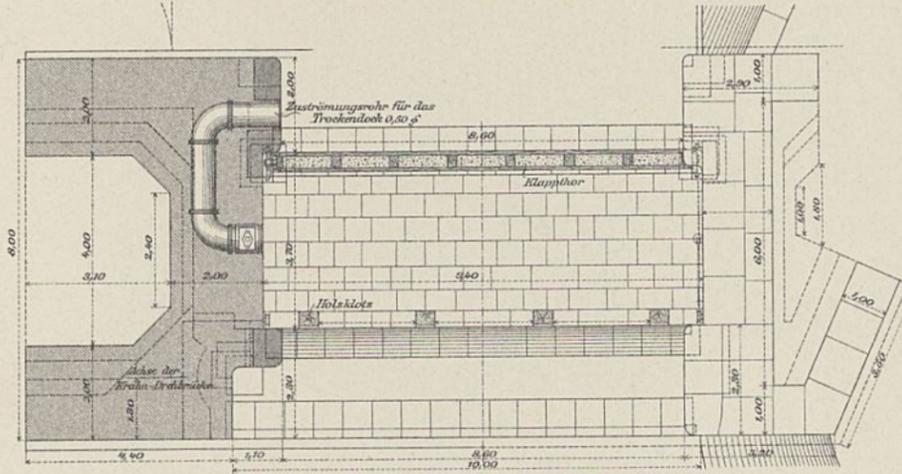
Grundriss des Hauptes. 1: 150.
